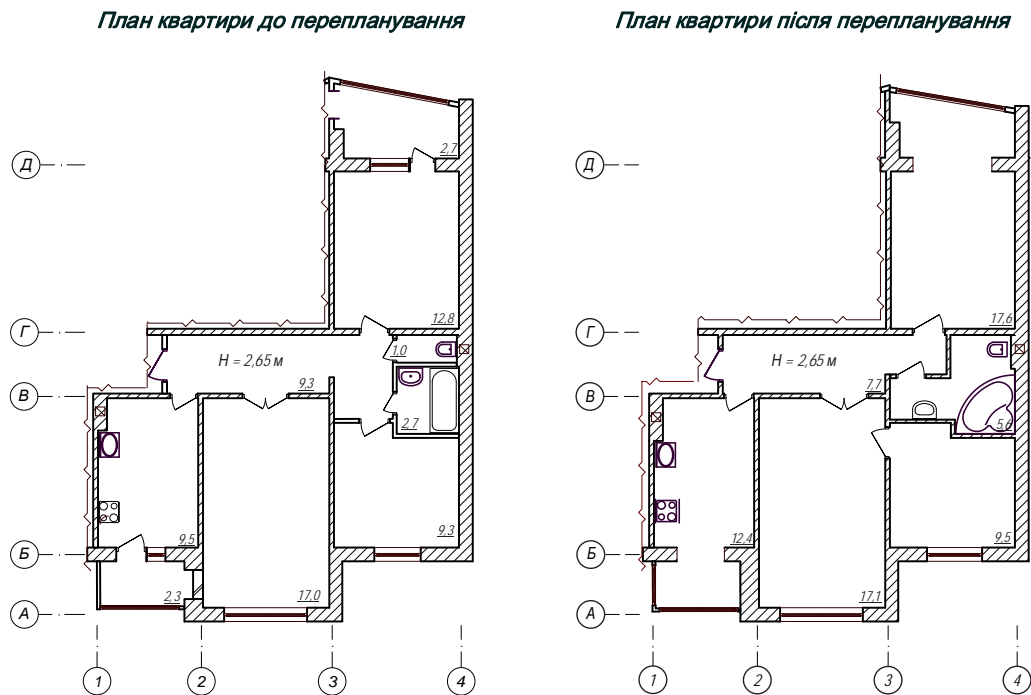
Найбільш поширений варіант перепланування трикімнатної квартири в житловому будинку серії КР-111-94
